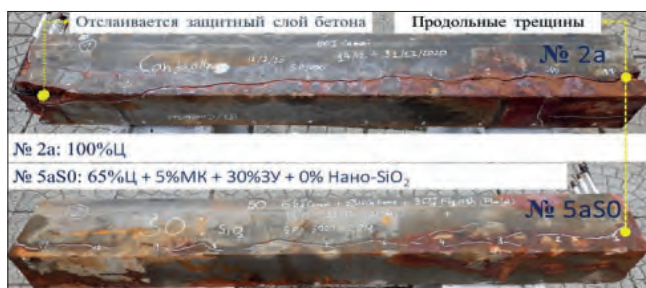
Коррозионные трещины на поверхности армированных бетонных образцов-балок составов № 2a и 5aS0
